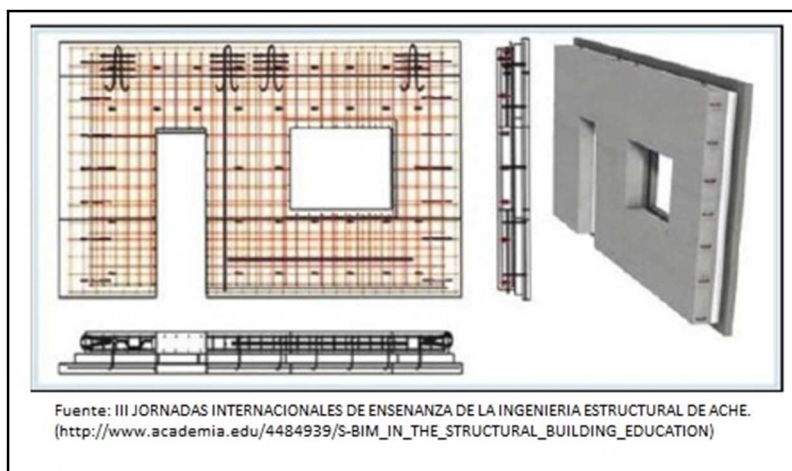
Planos y modelo de muro prefabricado en metodología s-BIM
